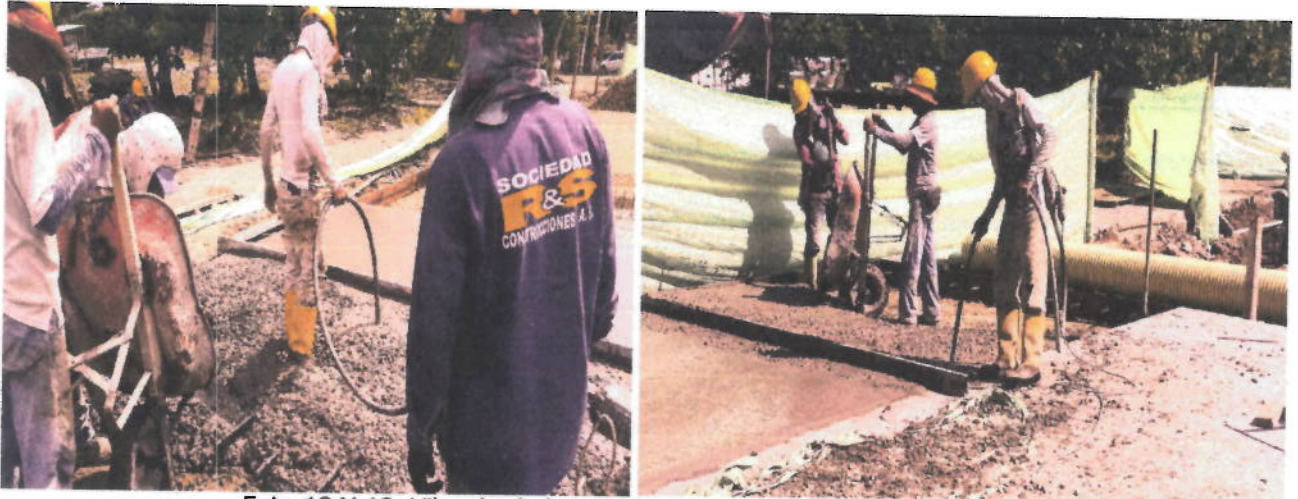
Y 19. Vibrado de la mezcla del pavimento de concreto
